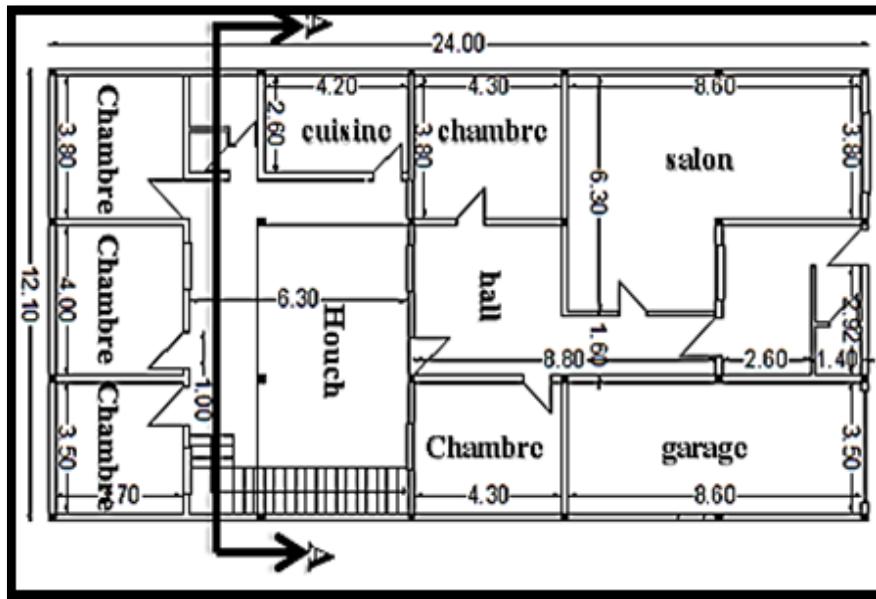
plan de 4<sup>ème</sup> maison a cour –RDC-
